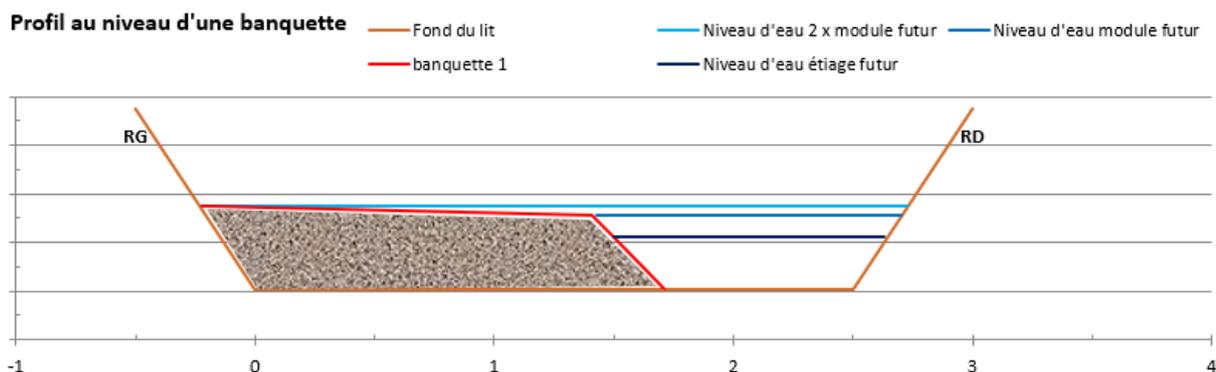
Schéma type d'un profil en travers au niveau d'une banquette
